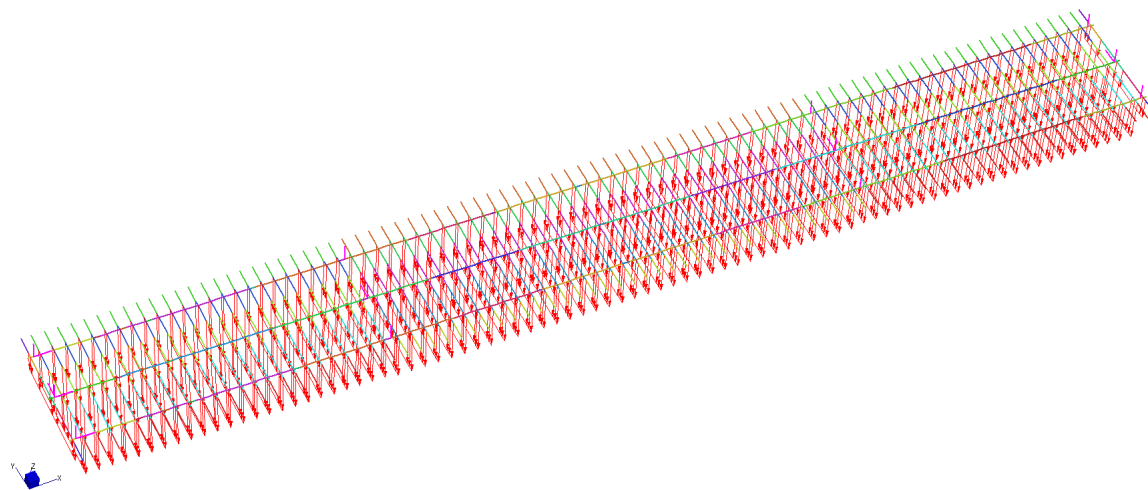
Applicazione dei carichi di FASE II (pavimentazione stradale)
